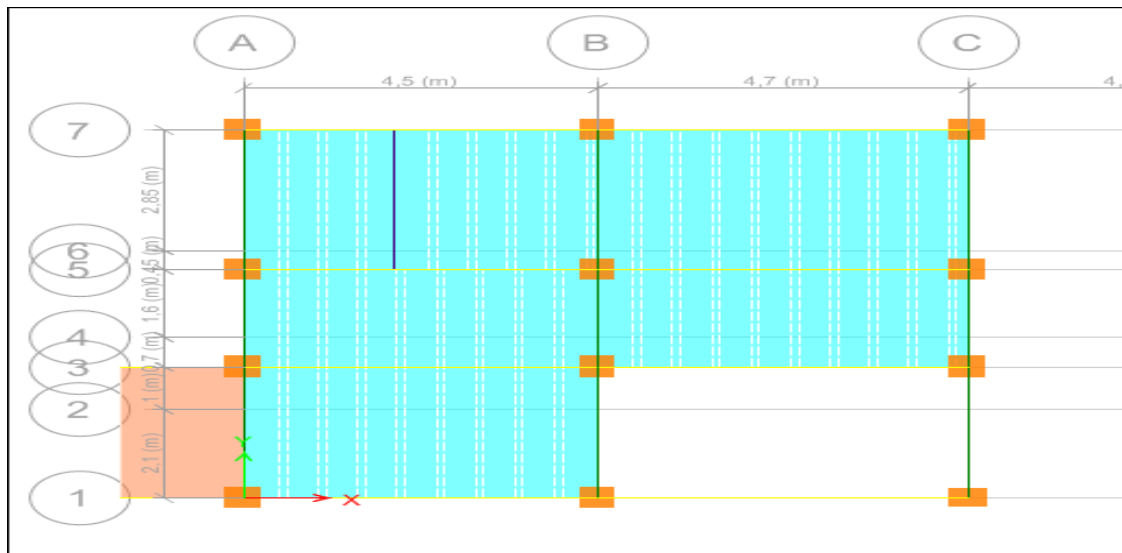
Vue en plan de la disposition des poutrelles du l'entre sol 3.
